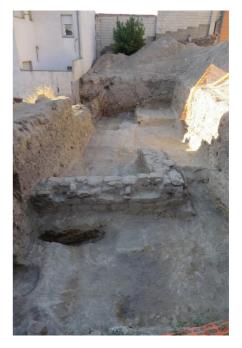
Planteamiento de Control de movimientos de tierra en zona muro por bataches
